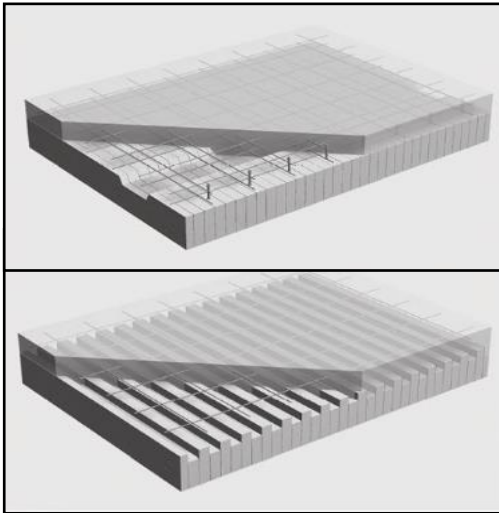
Plancher bois-béton avec éléments de planches juxtaposées
